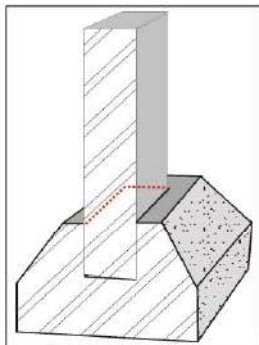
Detalhe da inserção do pilar no elemento de fundação
